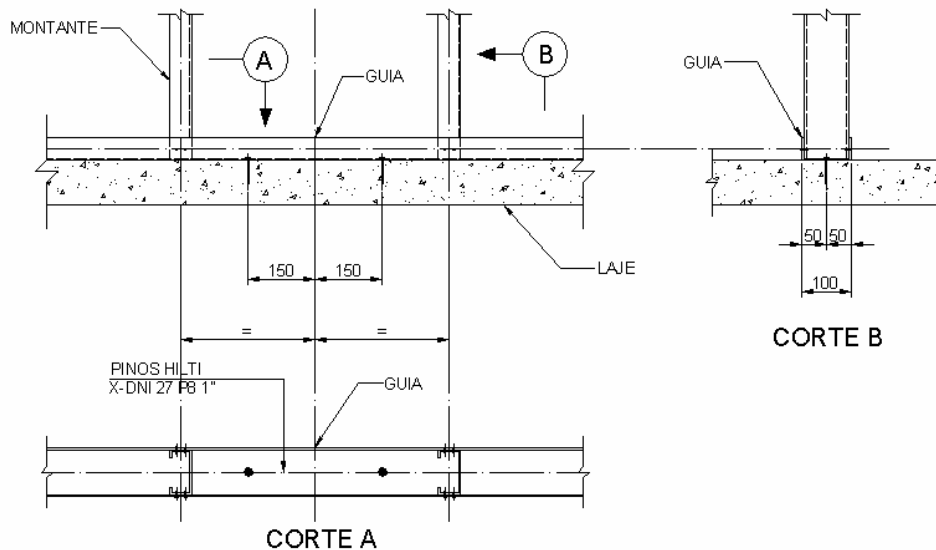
Detalhe construtivo da ligação Guia - Laje [3]
